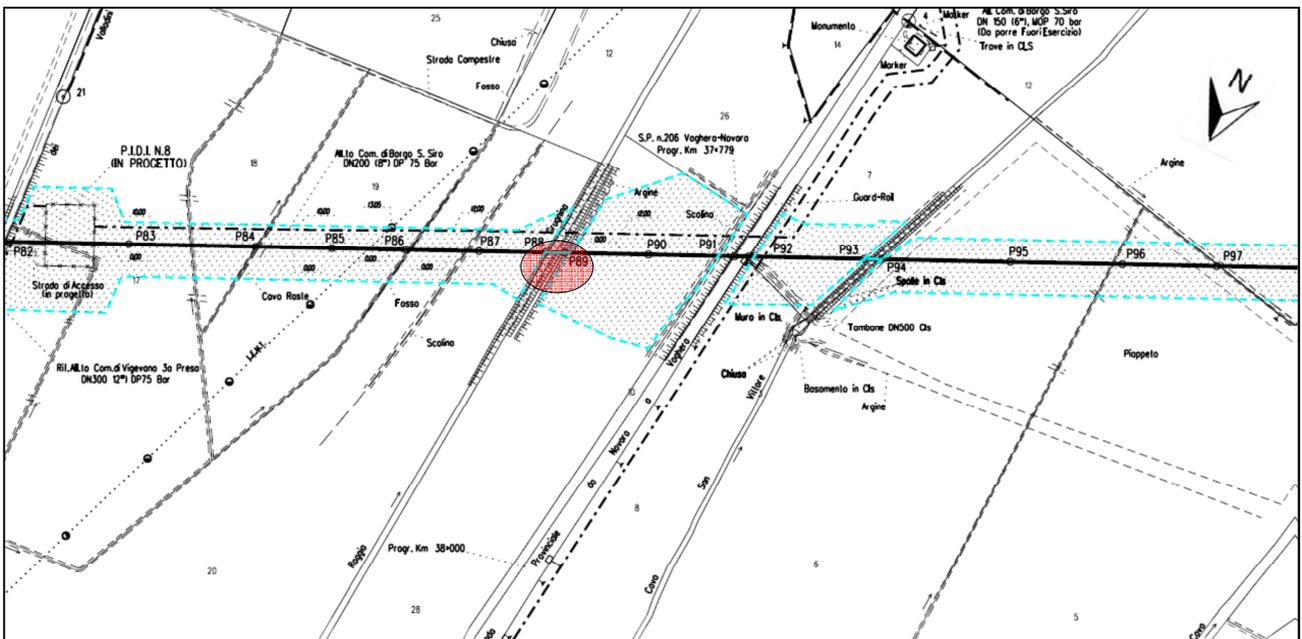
Localizzazione Area Test VEP 07 VG su planimetria catastale
